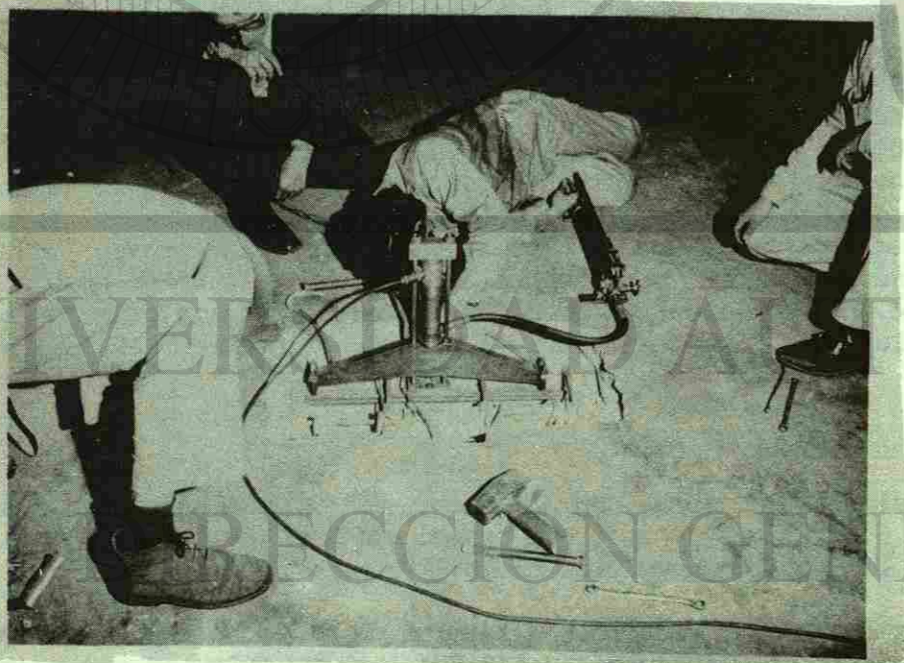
Aparato construido para medir la tensión en los cables de las vigas postensionadas.
